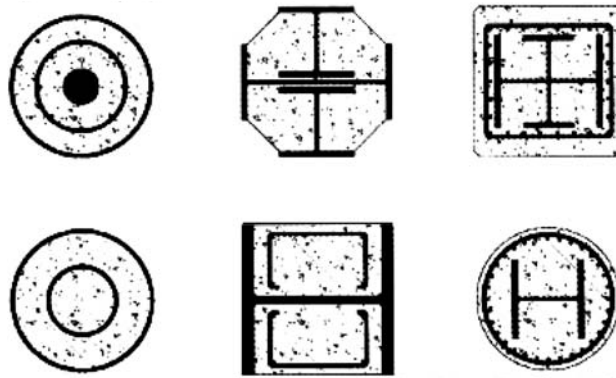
Перерізи сталезалізобетонних колон
